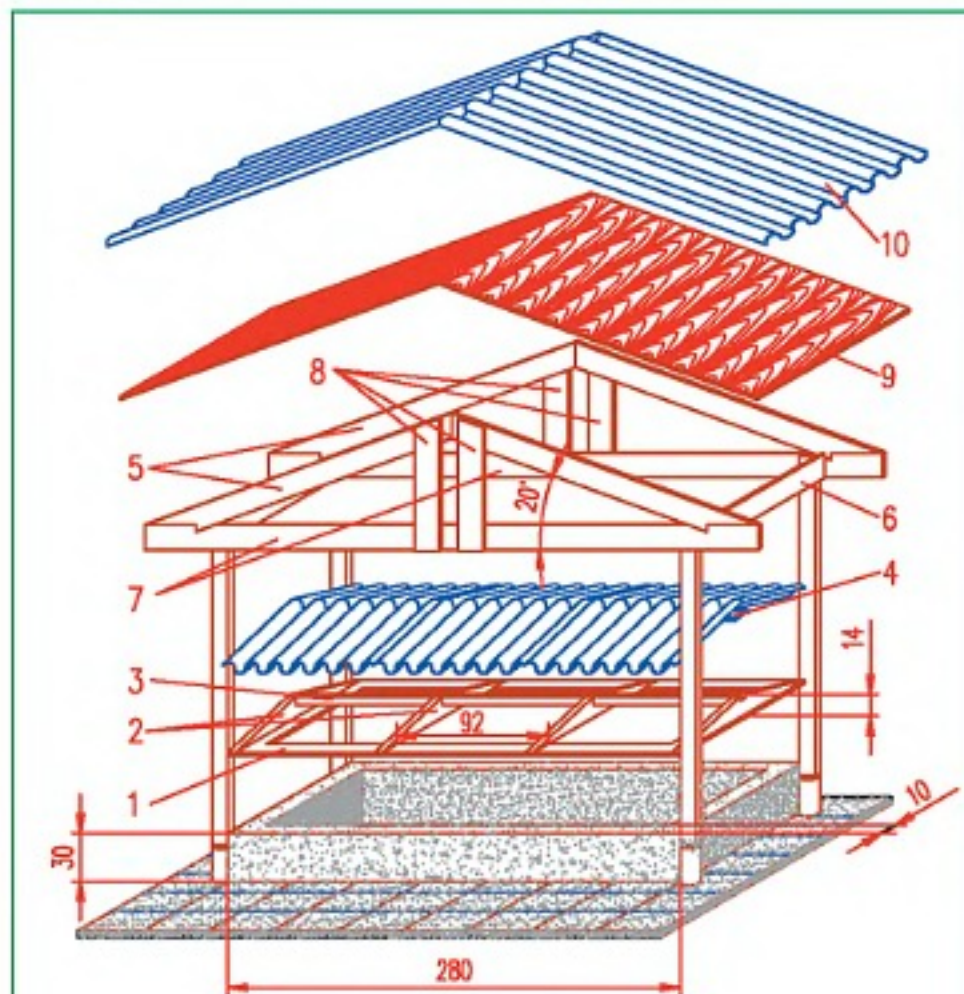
Общий вид компостария: 1 — площадка; 2 — цоколь; 3 — трубы; 4 — столбики; 5 — каркас крыши; 6 — крыша; 7 — откидывающиеся крышки.
